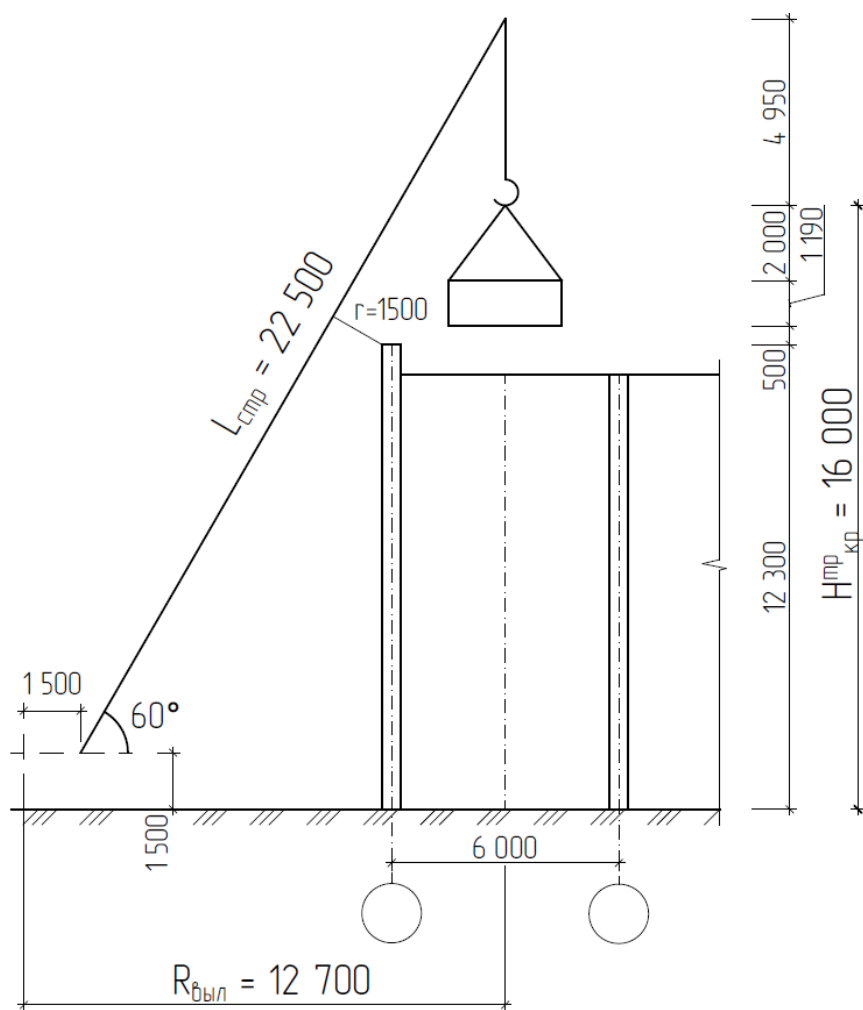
Поперечный разрез здания (М 1:200)
